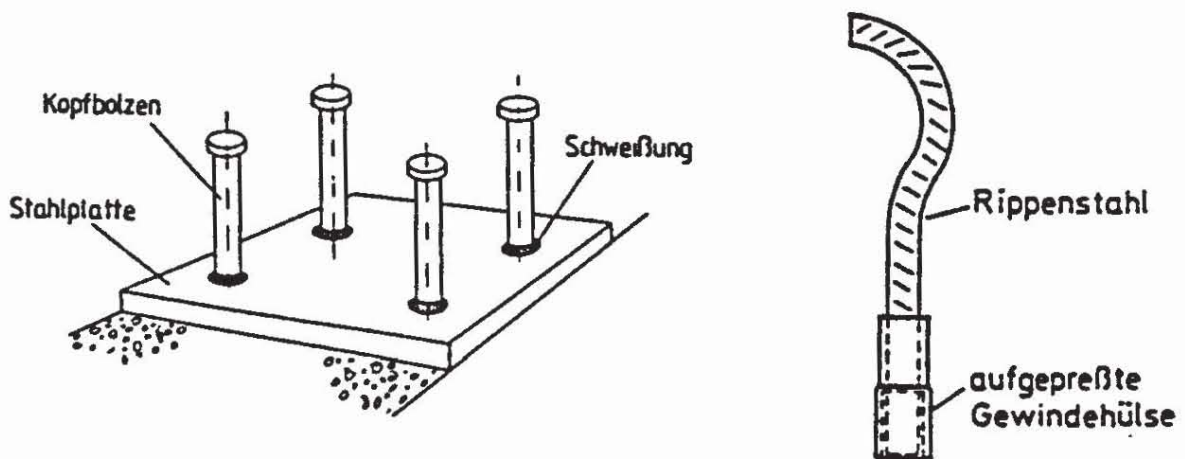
Stahlplatte mit angeschweißten Kopfbolzen, nach /1/
